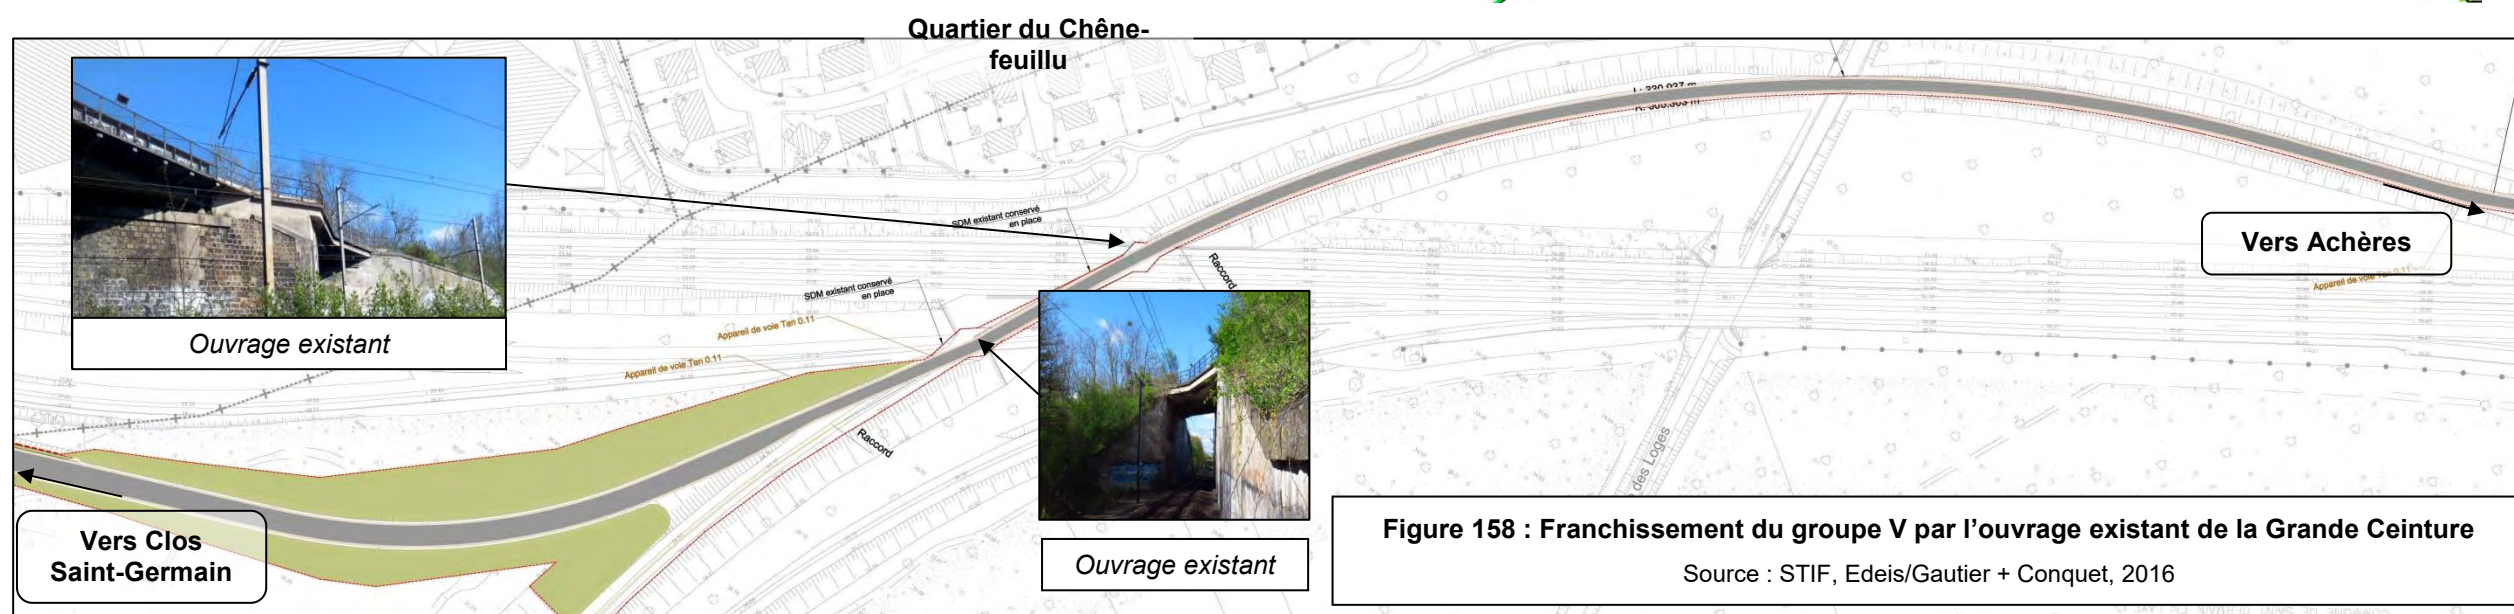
Franchissement du groupe V par l'ouvrage existant de la Grande Ceinture
